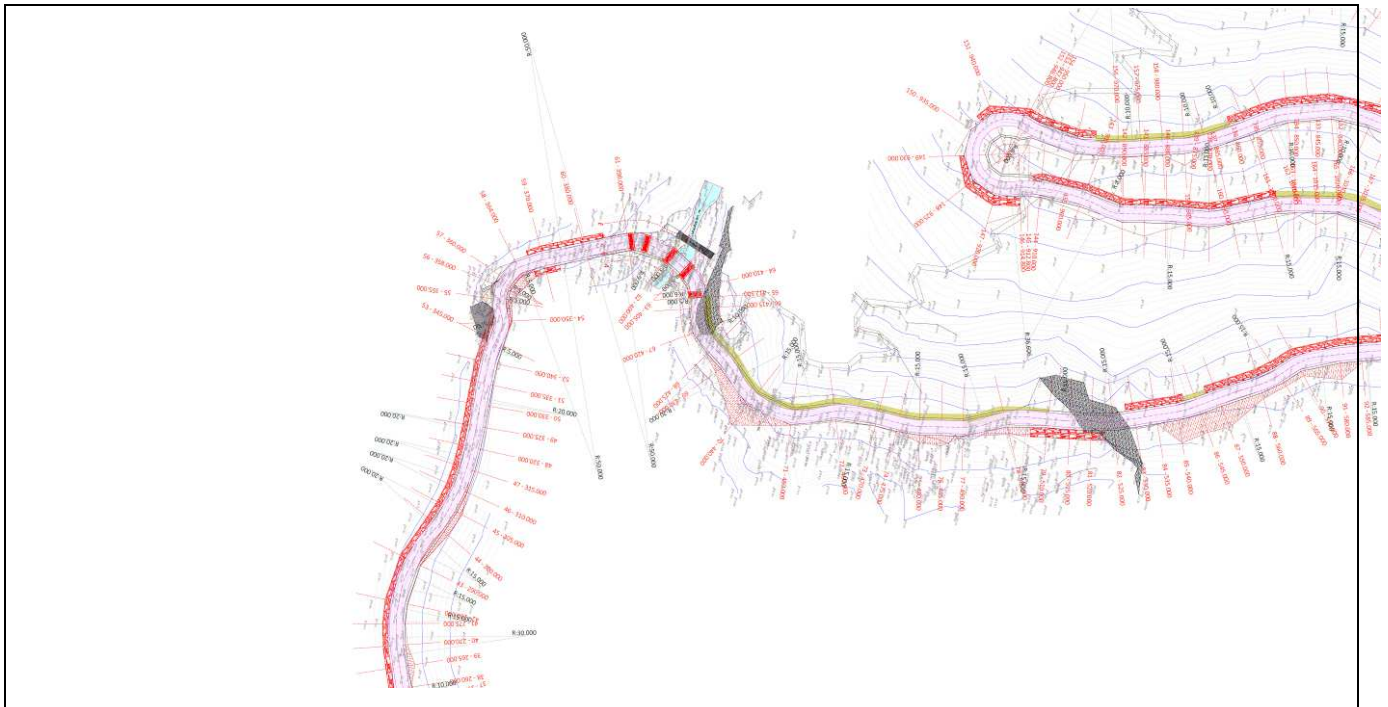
estratto planimetrico tratto attraversamento val Bolgadregna [tavola B3 Studio Maraaffio]
